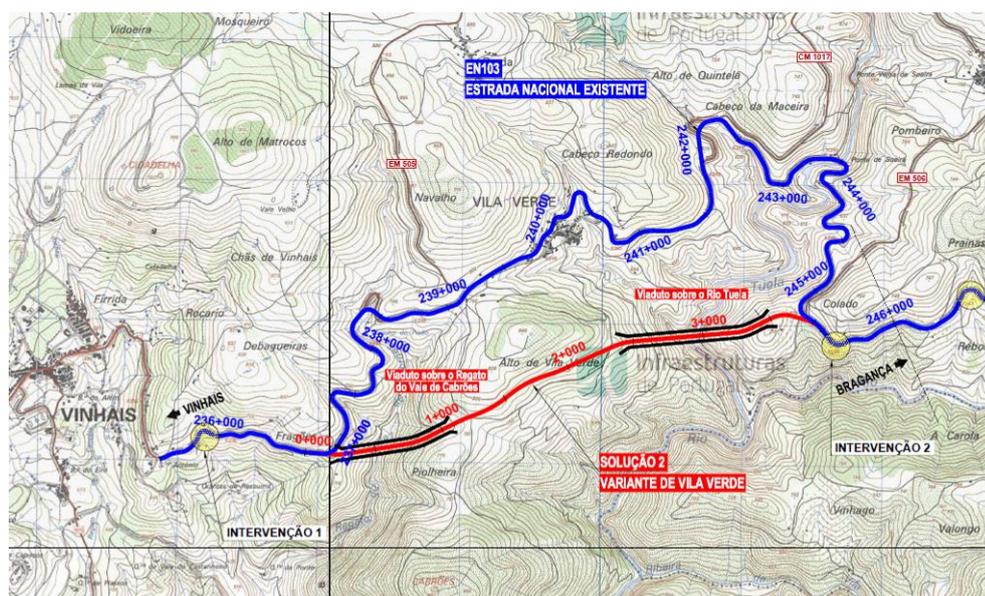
Implantação da Variante de Vila Verde – Solução 2
